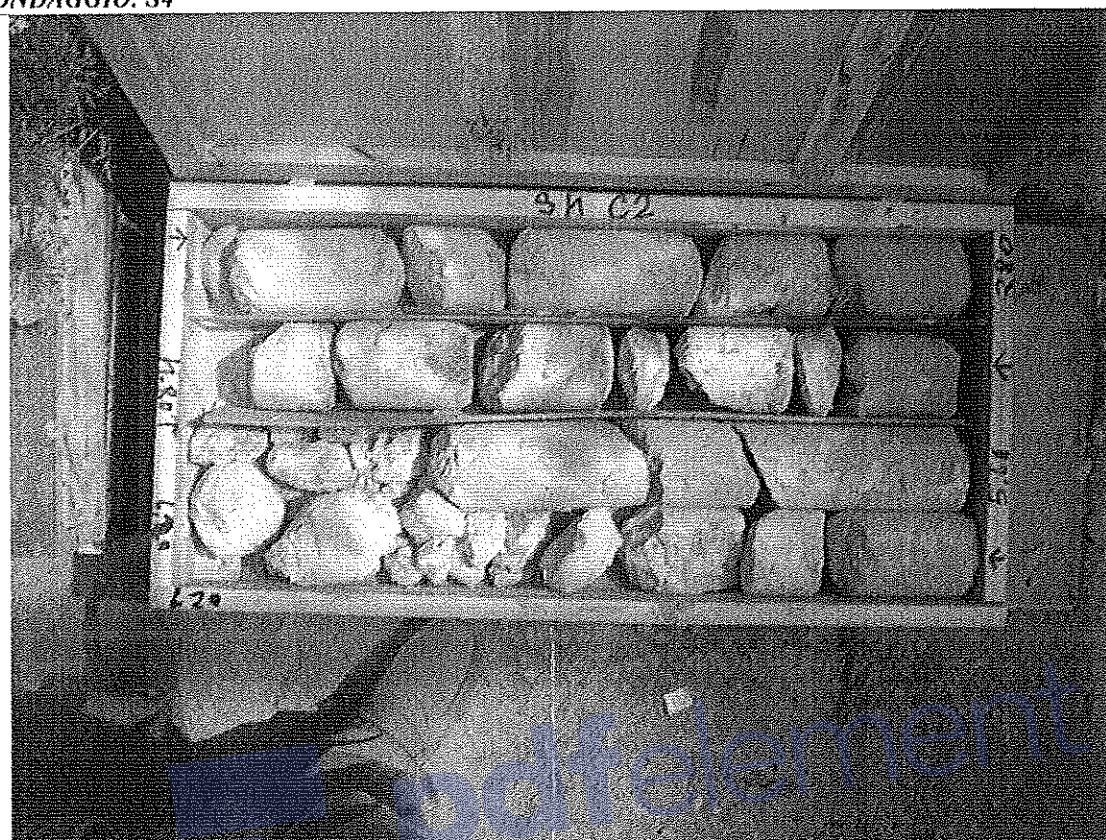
SONDAGGIO S4 CASSETTA C2
